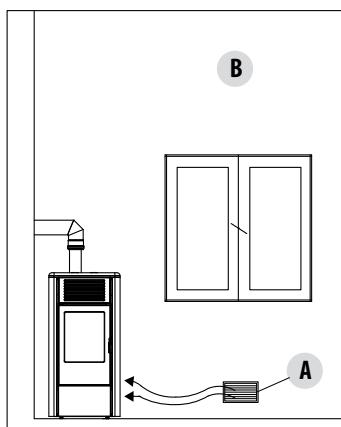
A - DIRETTAMENTE DALL'ESTERNO
